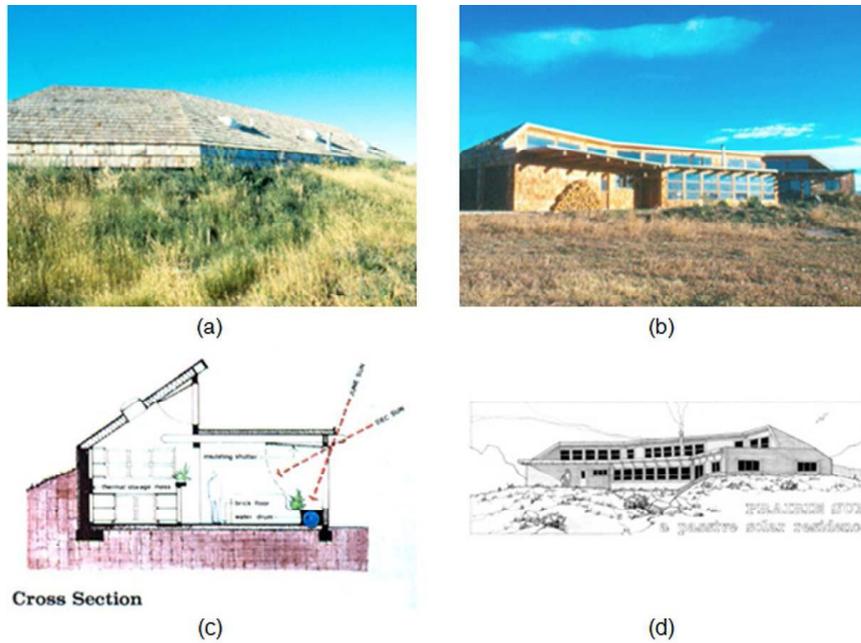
David Wright, Prairie Sun, Cody, Wyoming, E.U.A, (1979): (a) Vista exterior – fachada posterior, (b) Vista exterior – fachada principal, (c) Sección transversal, (d) Perspectiva.
